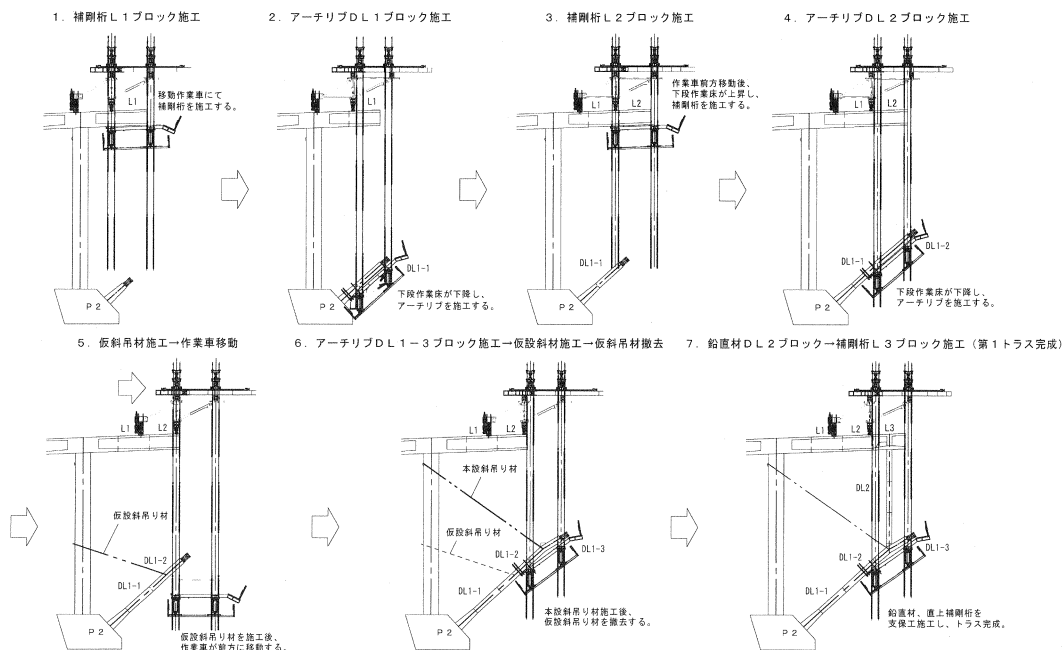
第1トラス形成までの施工ステップ(アーチリブ分割施工)
